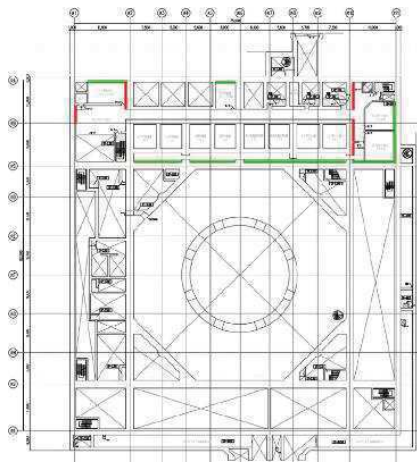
(1) ひび割れ多寡状況図 (女川原子力発電所第 2 号機原子炉建屋)
